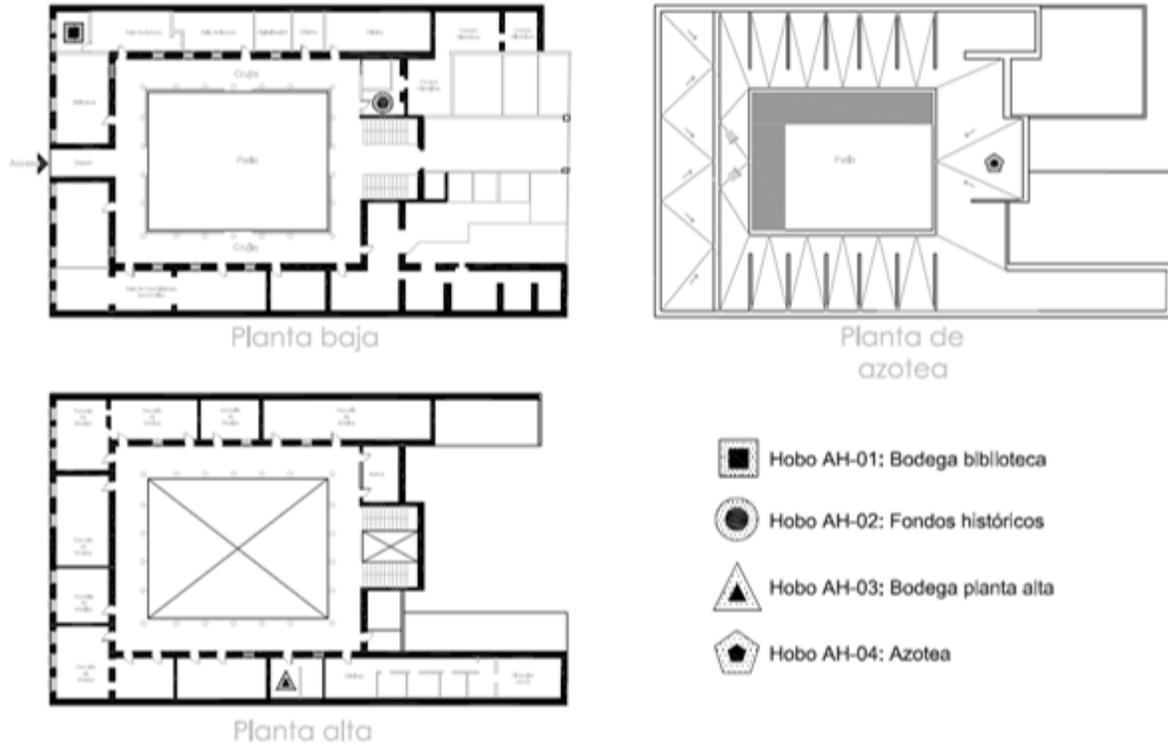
Localización de los Data loggers (HOBOS) en las plantas arquitectónicas; planta alta, planta baja y azotea, durante temporada cálida.
